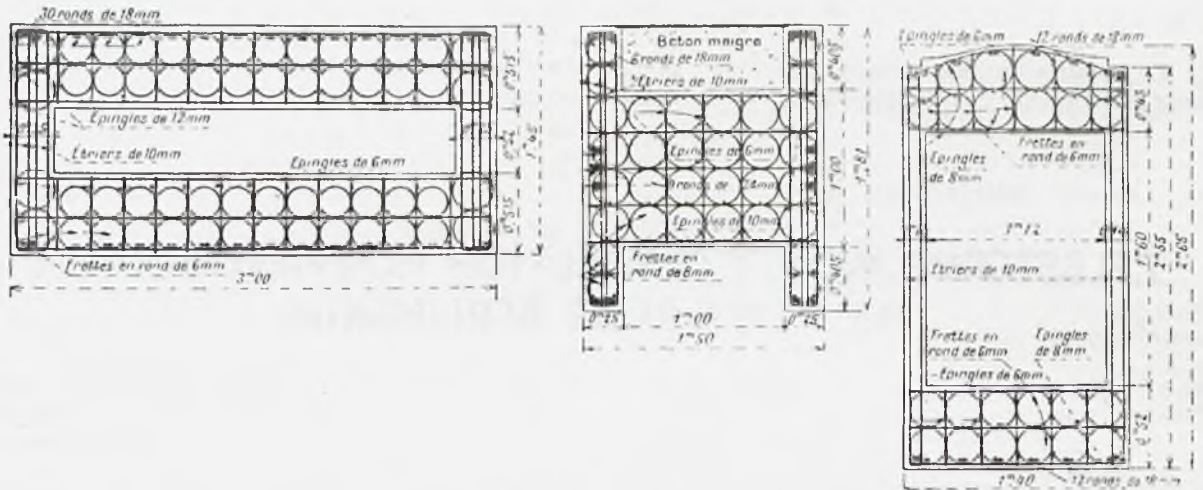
Przekroje poprzeczne łuku w Roche Guyon. Z lewej strony — w węzłowi, z prawej w kluczu. Oznaczenia francuskie: rond = żelazo okrągłe, étriers = strzemiona, frettes = zwoje, epingle = szpilka, krótki drut.
